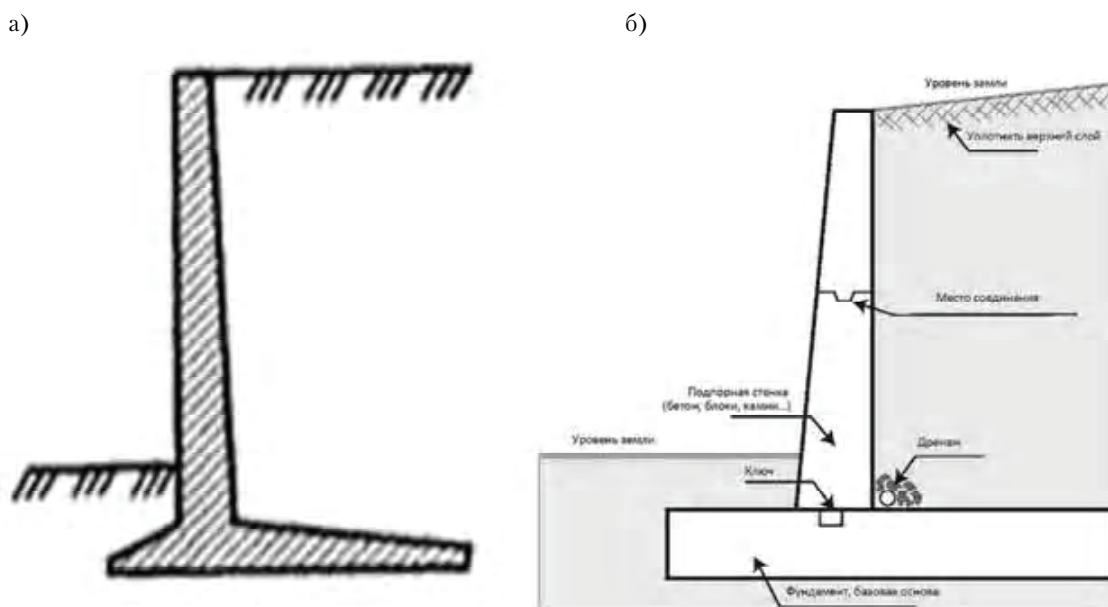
Схема монолитной (а) и сборной (б) железобетонной подпорной стенки.
